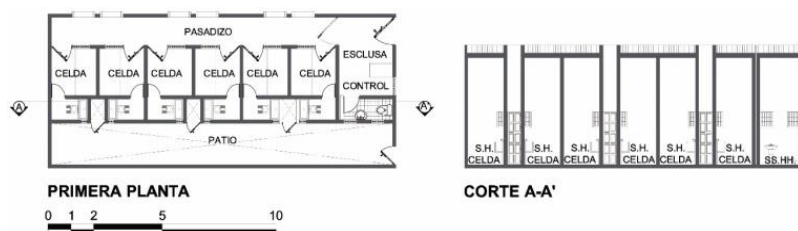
Plantas y corte del pabellón de aislados de la zona A
